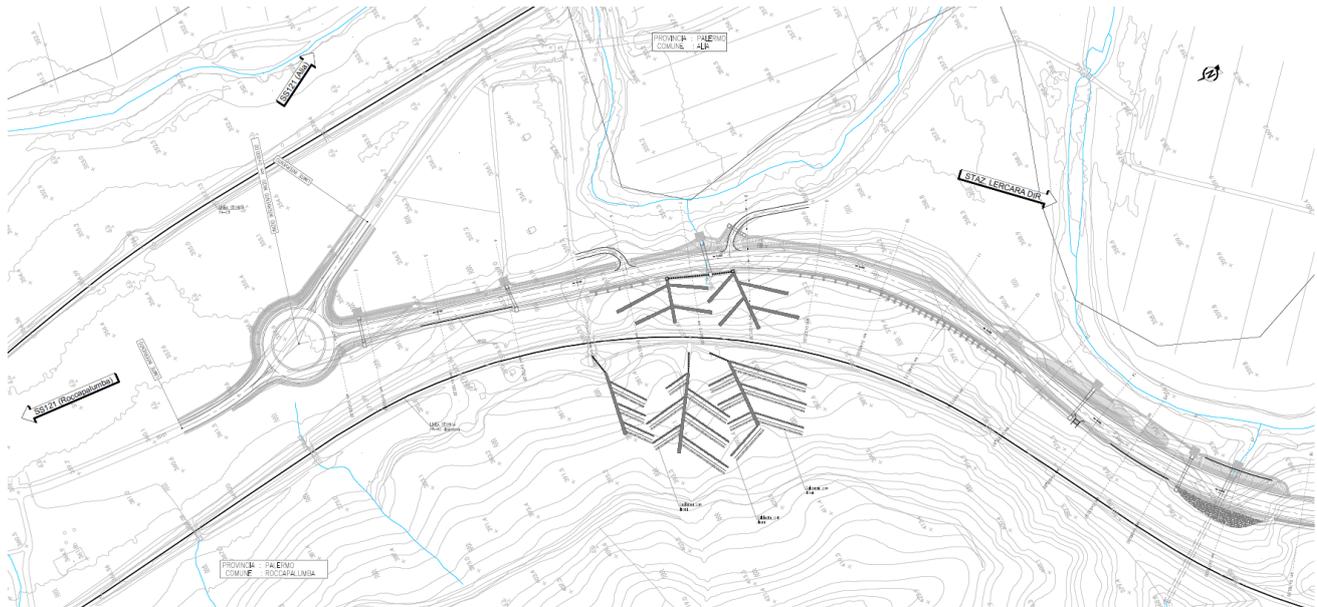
Planimetria di progetto dalla Km 0+000 alla Km 0+750
